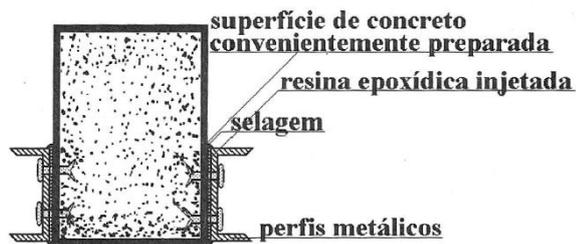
Viga de concreto-armado reforçada com perfis metálicos.
